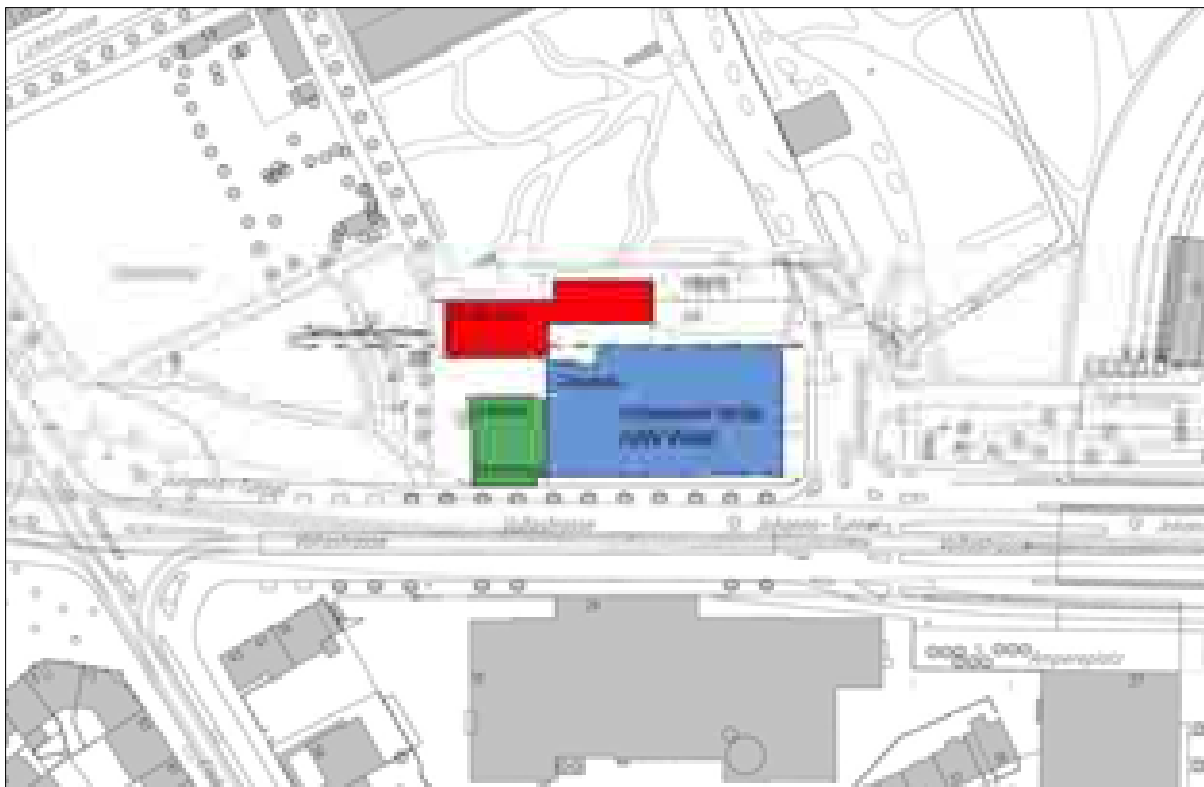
Schemaplan UW Volta (Kein Massstab, Plan genordet)
